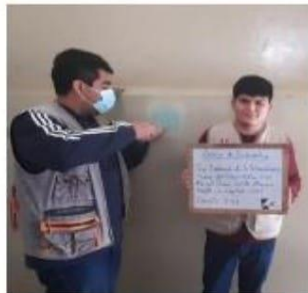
Ensayo de Esclerometria para Viga 01 en Pabellón Razuri. Viga interior, angulo de rebote a +0°
